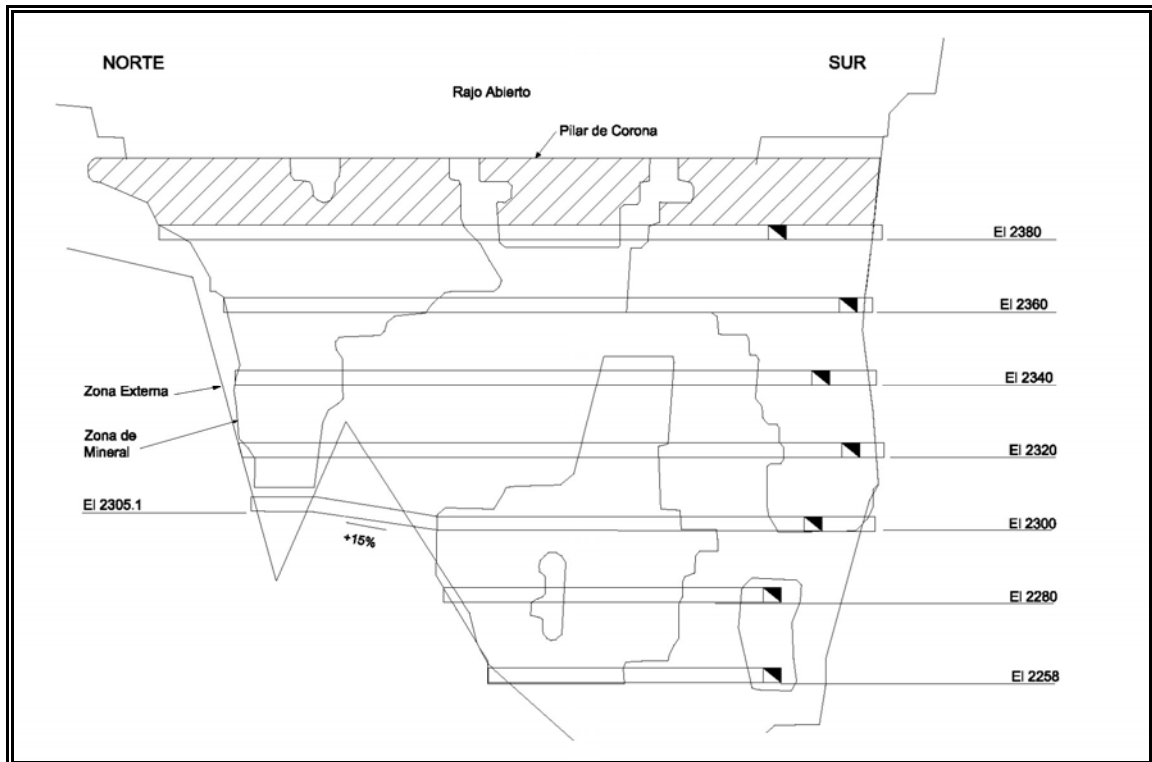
Sección Longitudinal de la veta Aztec.
